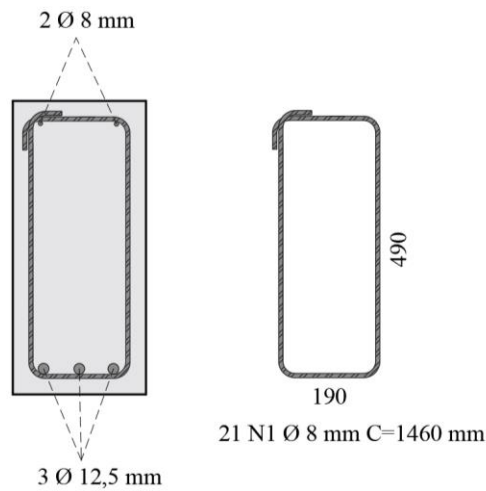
Detalhamento transversal das armaduras das vigas ensaiadas.
